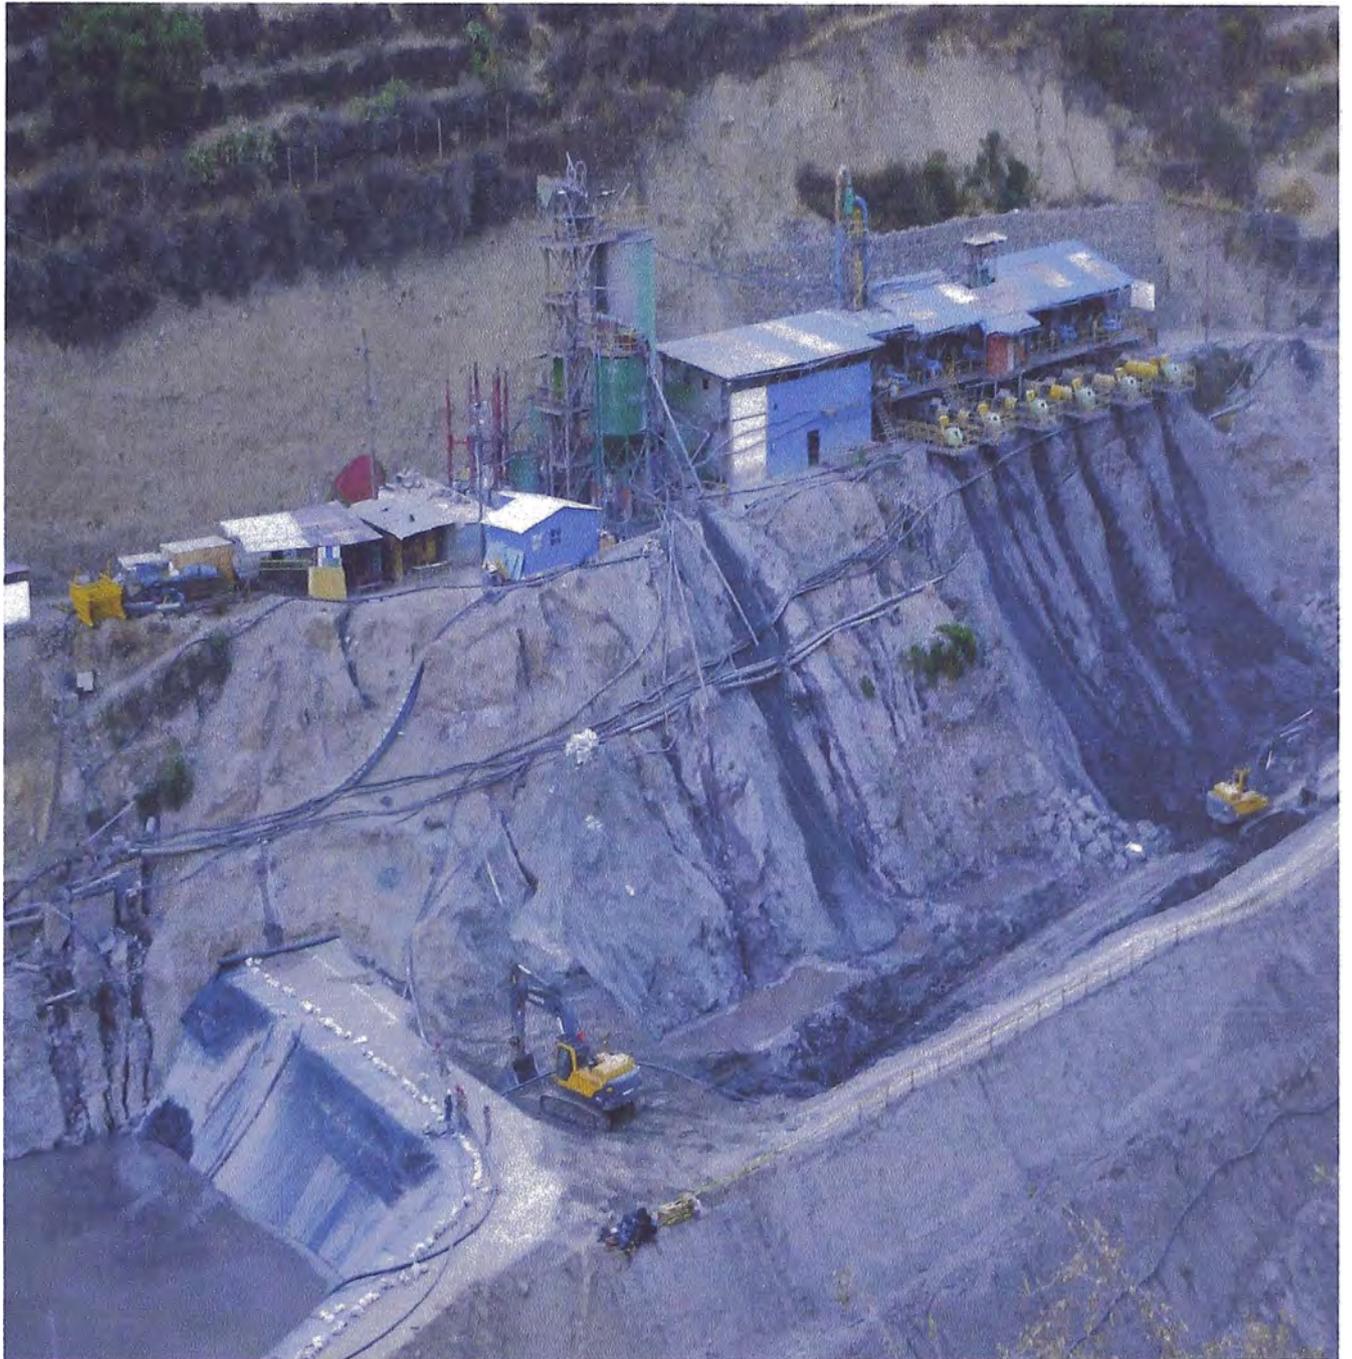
Vista de la planta de filtrado de relaves de CMCHSAC
